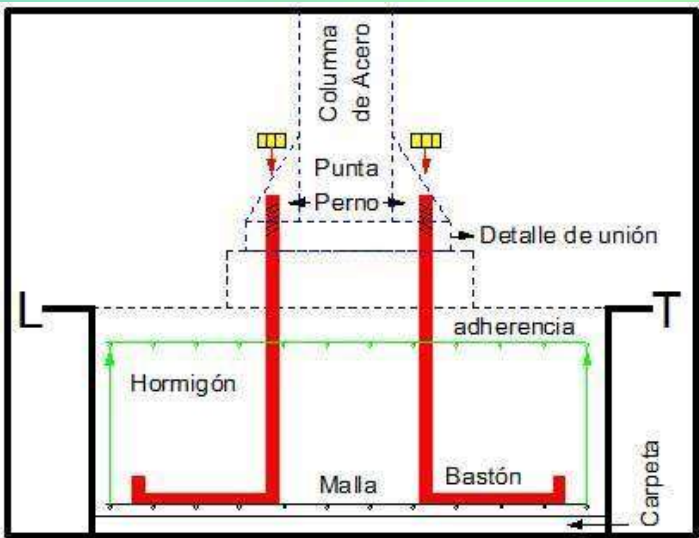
, Unión de Columna de Acero con Zapata, Foto EDGM
